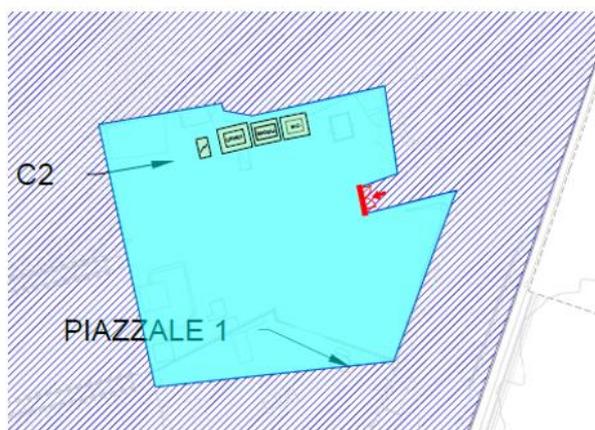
area di cantiere C2 - Layout di cantiere ed inquadramento territoriale
